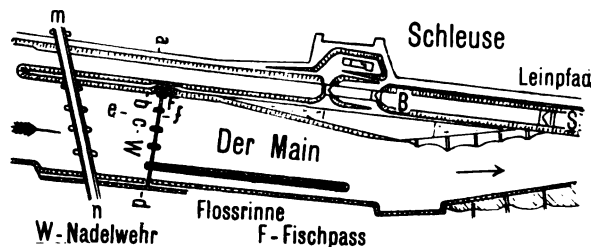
Grundriß von Wehr- und Schleusenanlage bei Frankfurt a. M.
